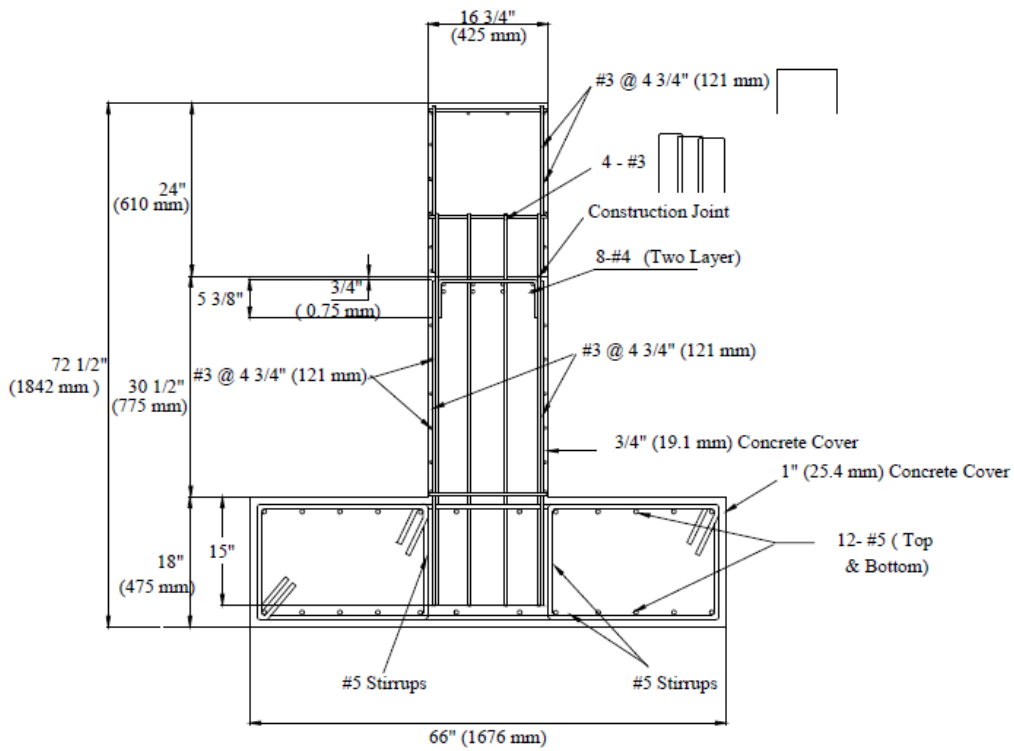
Sección B-B de Refuerzos – Serie 4 Externa (Bozorgzadeh et al., 2007).
